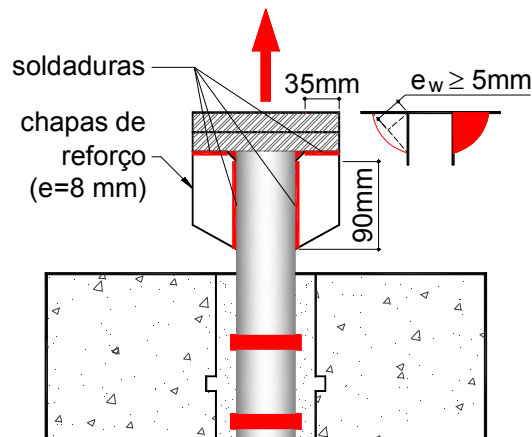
Pormenor do reforço da ligação chapa / tubo
